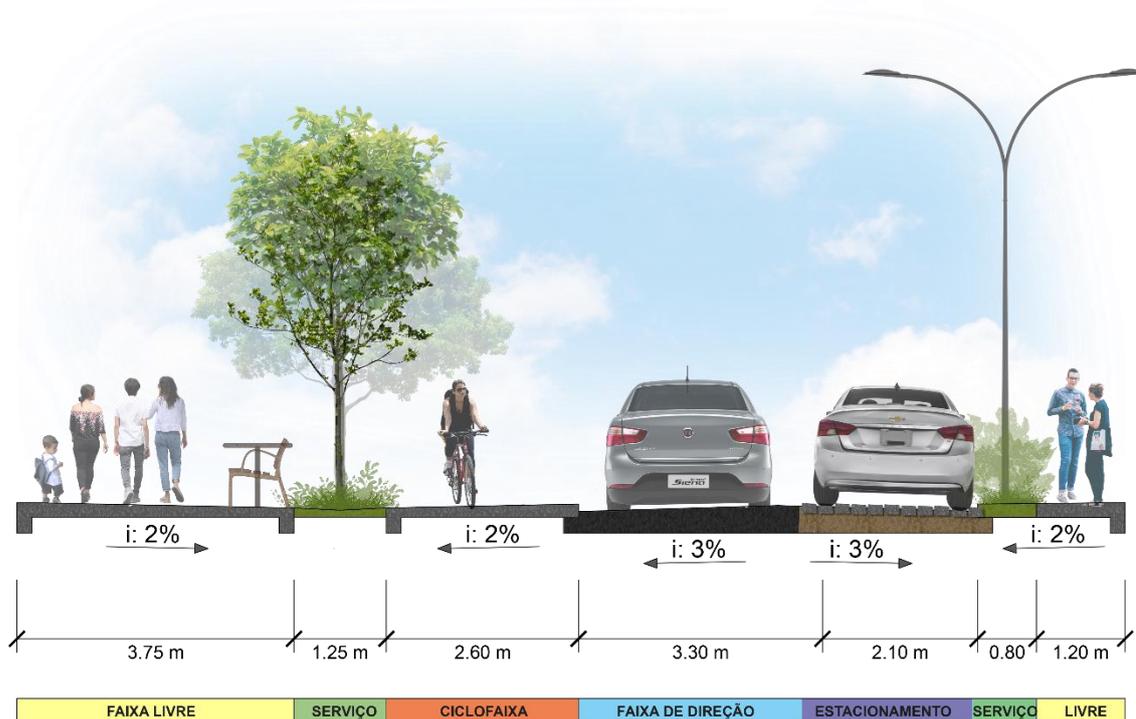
Planta Baixa de proposta para rua Nereu Ramos
